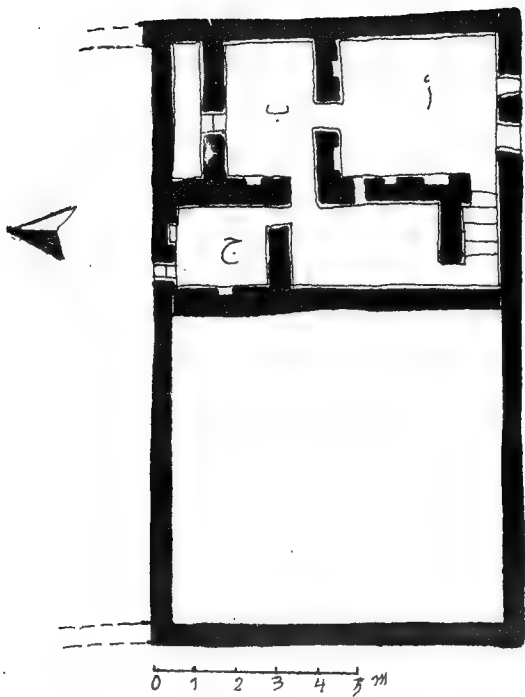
منزل ابو همام الراجية - مسقط رأسي
